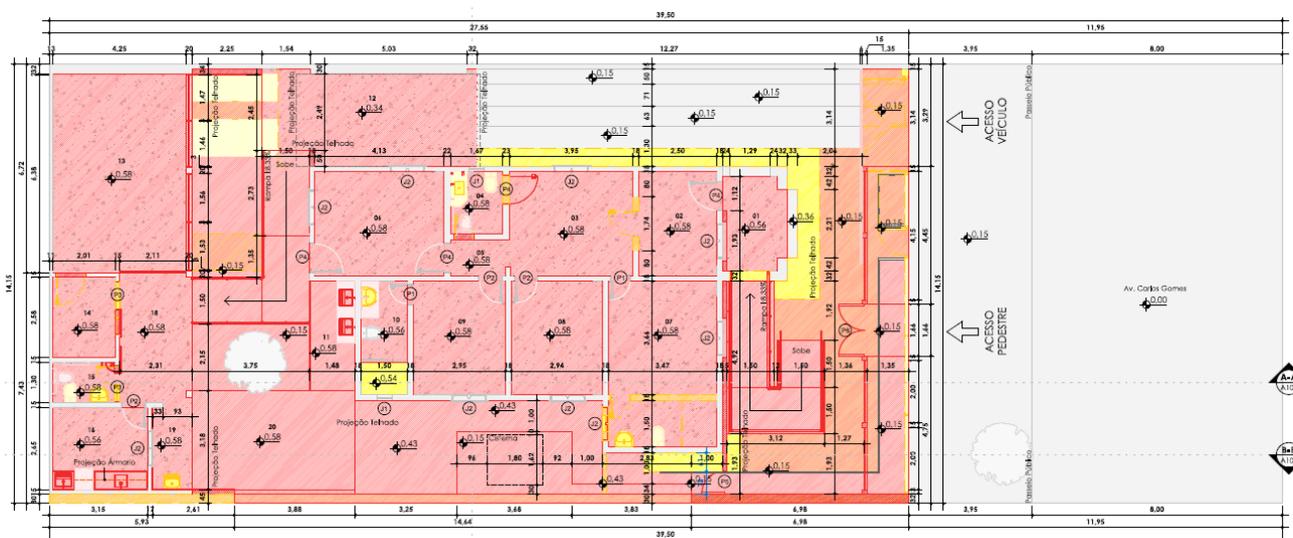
Planta Baixa Preservar, Demolir e Construir. Fonte: Arquivo Cau RO.
